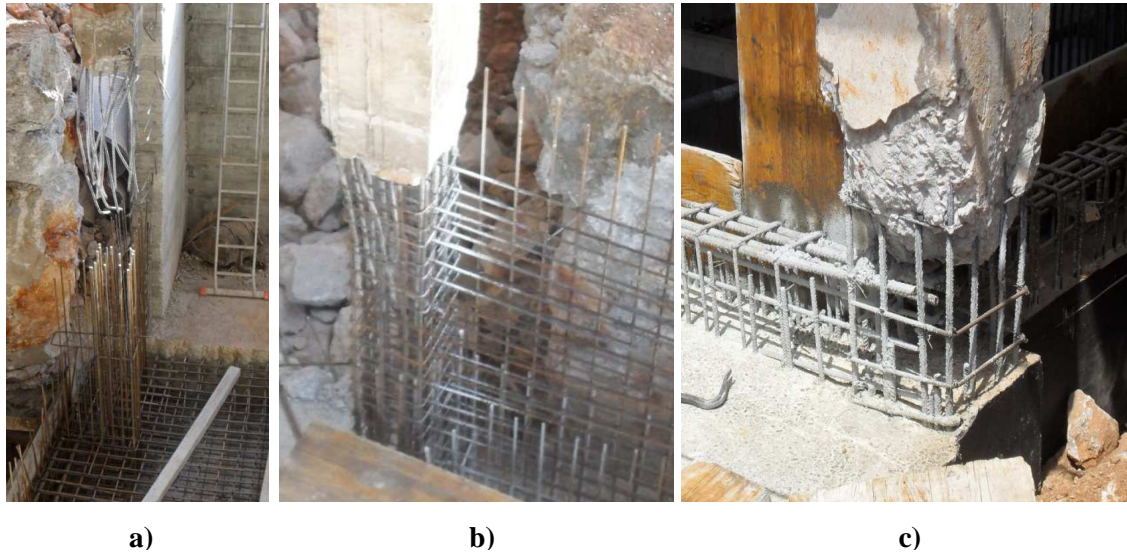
Execução do muro de suporte sob o pilar suspenso
